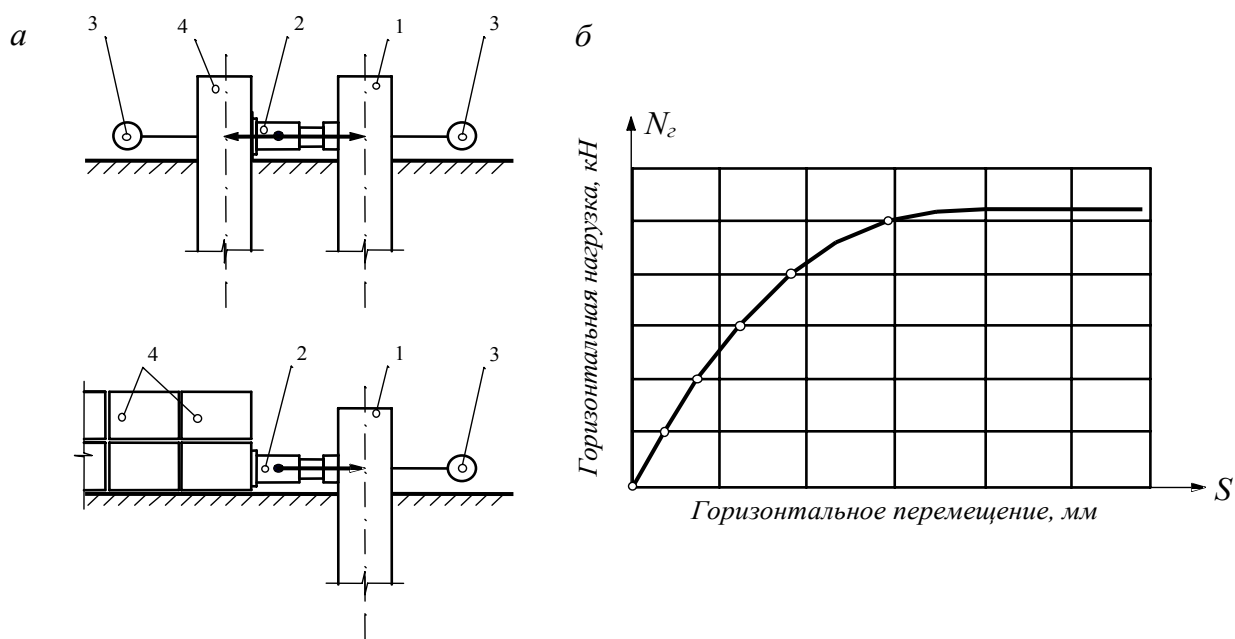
Испытания свай на горизонтальные нагрузки:
